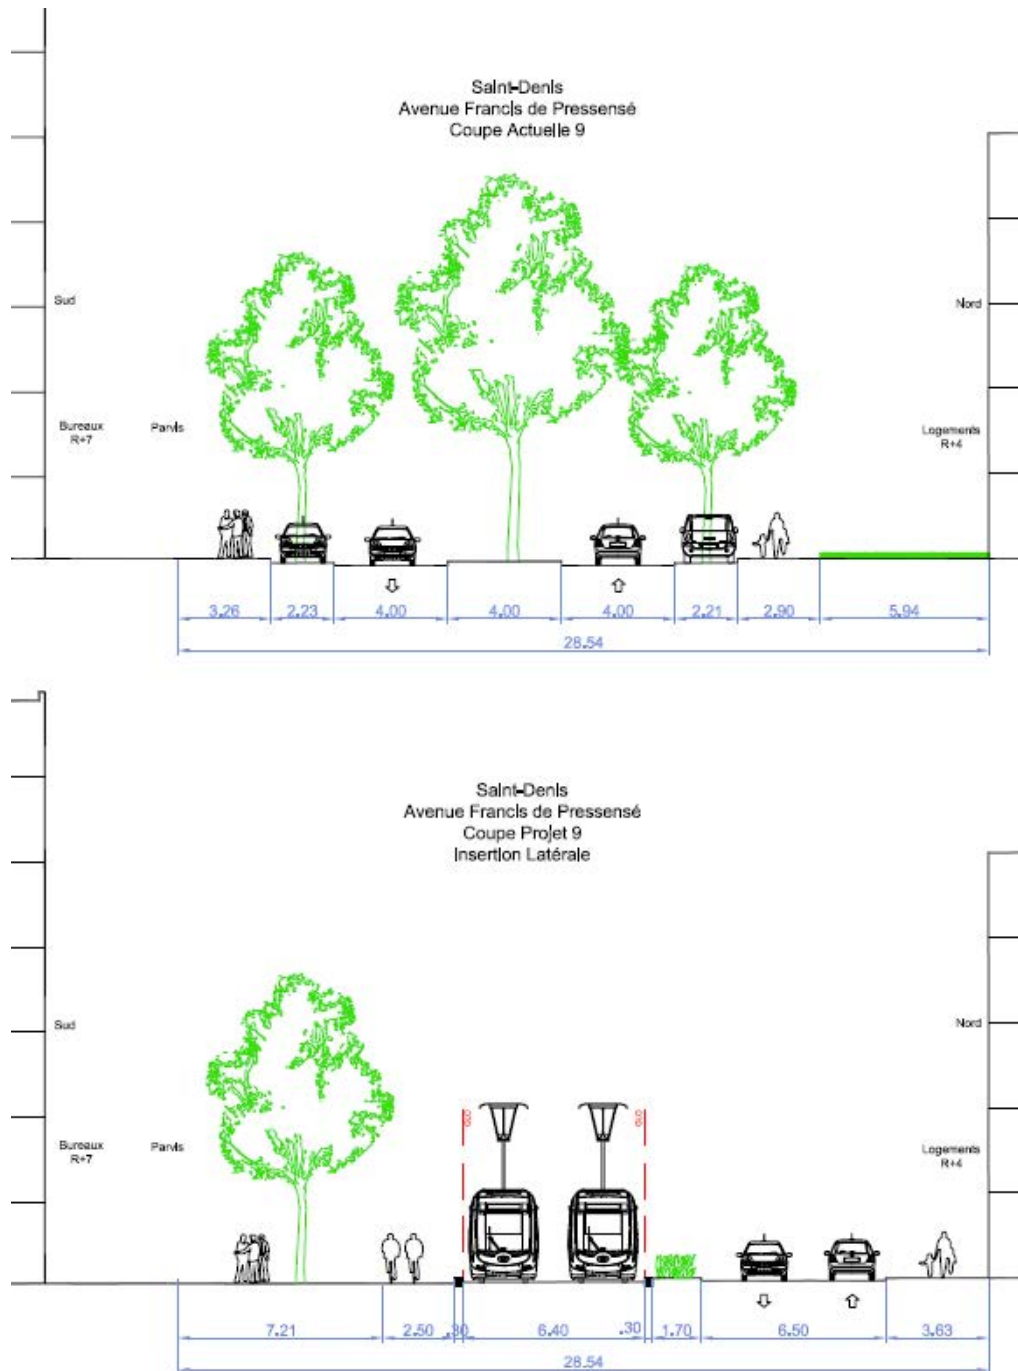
Insertion de la plateforme Tram 8 sur la rue Francis de Pressensé – ouest du Canal Saint-Denis (coupe n° 9)
